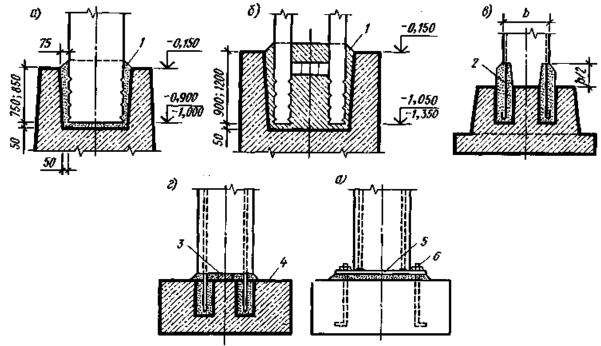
Стыки железобетонных колонн с фундаментами: а, б — посредством заполнения зазора бетоном; в, г — с помощью выпусков арматуры; д — с помощью анкерных болтов; 1 — бетон; 2 — арматура; 3 — стальная прокладка; 4 — фундамент; 5 — стальная плита; 6 — анкер
